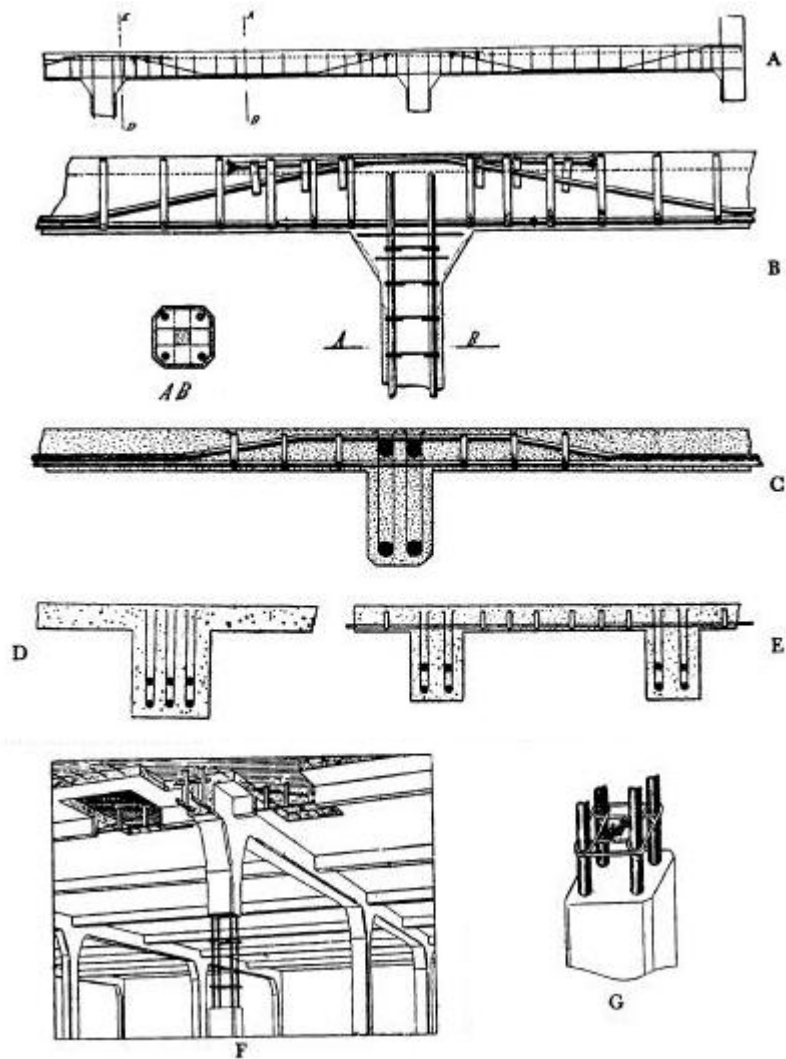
Sistema de concreto armado, por Hennebique em 1892 : a) corte longitudinal da viga; b) junção da viga com o piso; c) seção transversal da viga com o piso; d) seção da viga principal; e) corte das vigas secundárias com o piso; f) vigas principais, secundárias e piso, formando um conjunto monolítico; g) método da armação das colunas (IBRACON, 2011).
